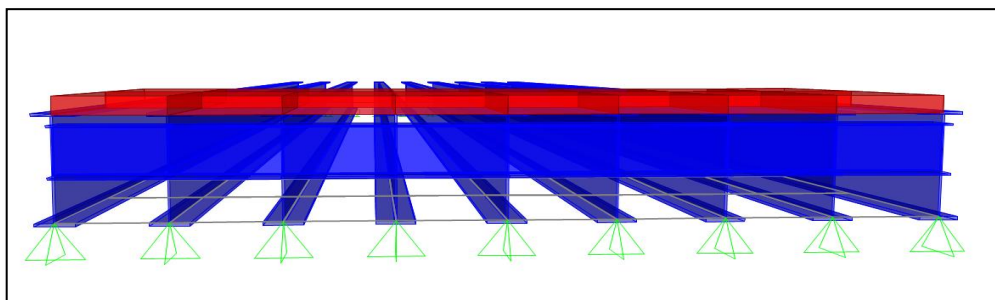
Model 1 (Balok girder tidak terbenam dengan *slab* beton).
